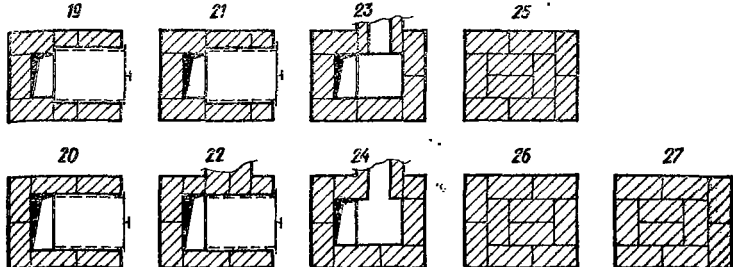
Отопительно-варочная печь с варочной камерой и духовым шкафом:
